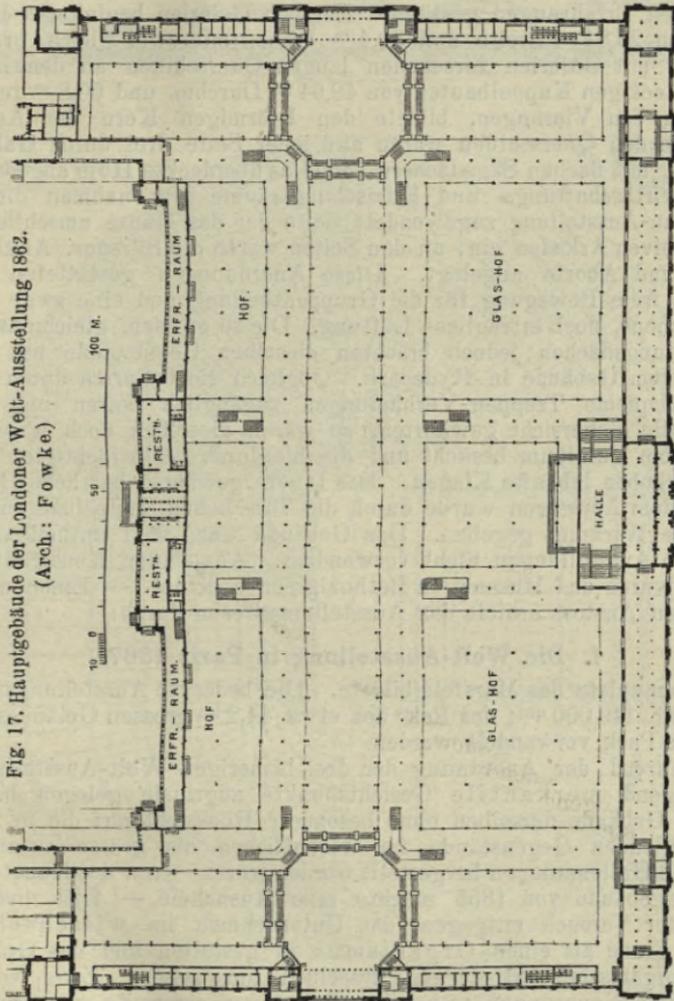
Hauptgebäude der Londoner Welt-Ausstellung 1862.
